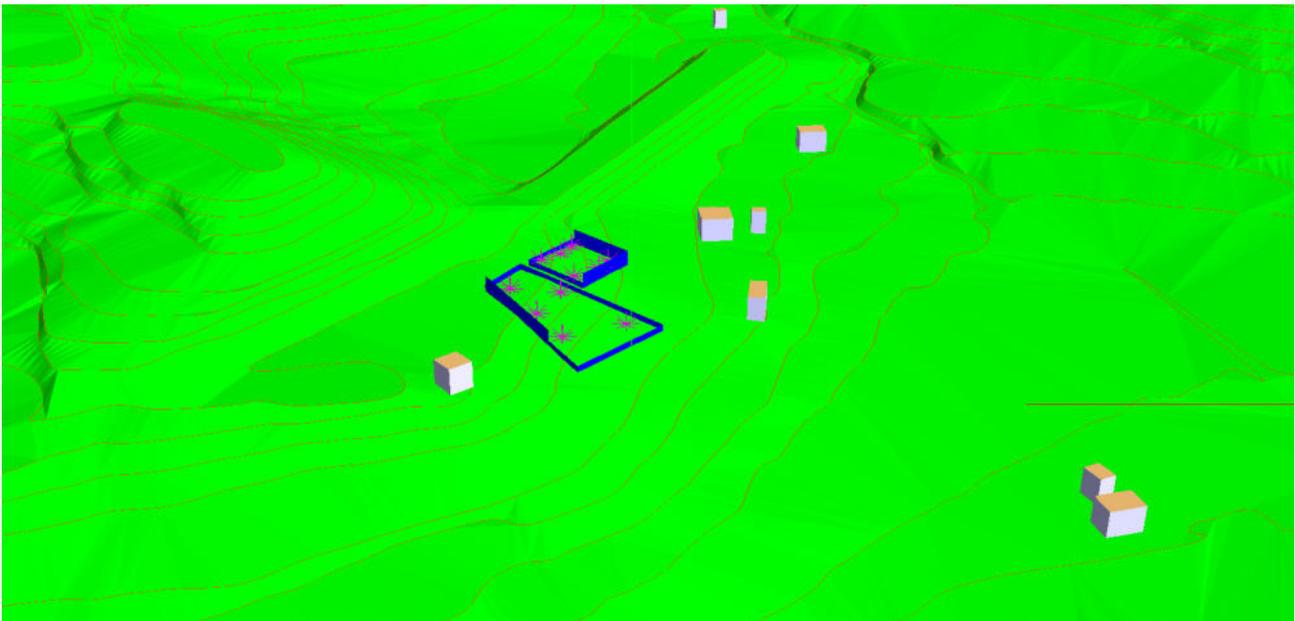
Modellazione tridimensionale in SoundPlan - in blu le barriere e recinzioni di cantiere
